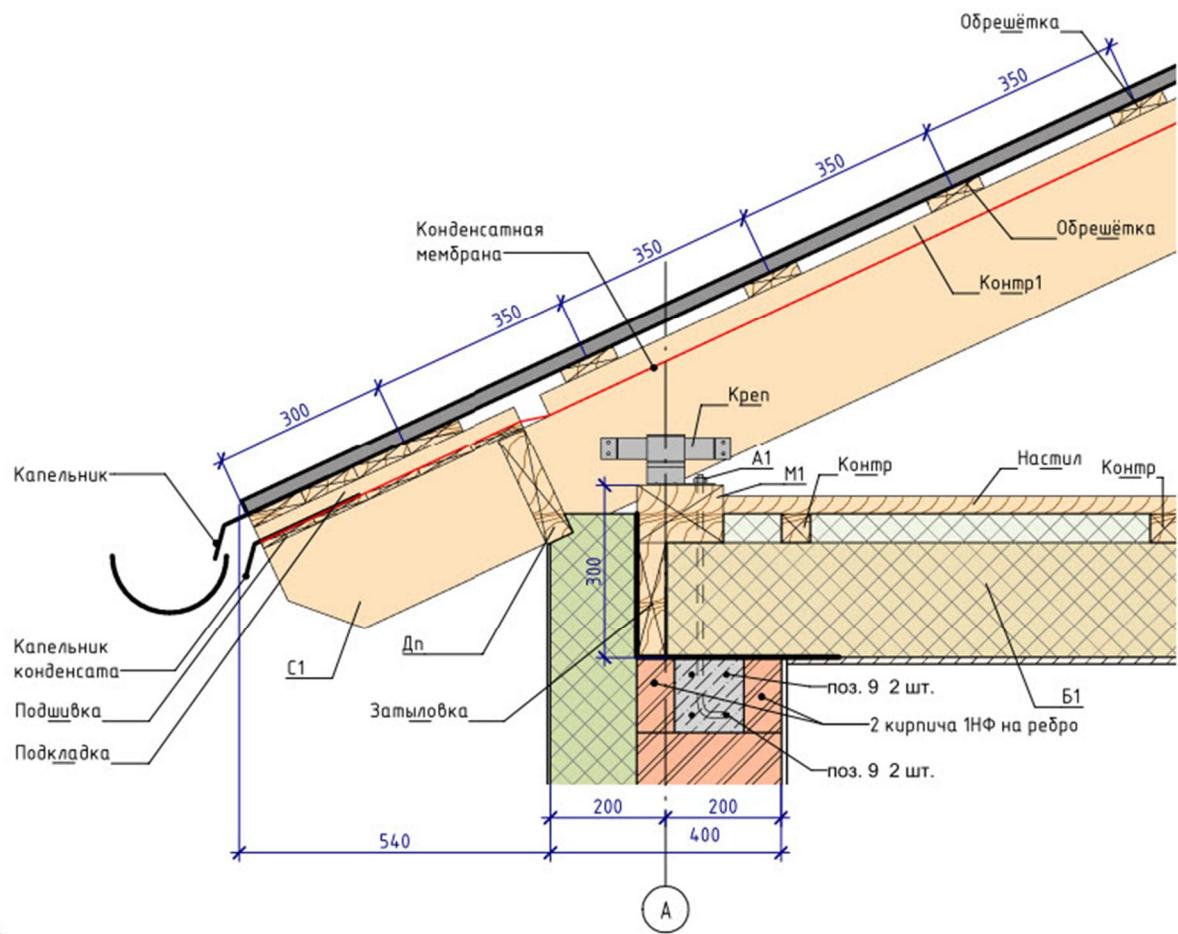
Узел опирания стропил на мауэрлат (опорный брус) для кровли из металлической черепицы с открытыми концами стропил на свесе кровли.
